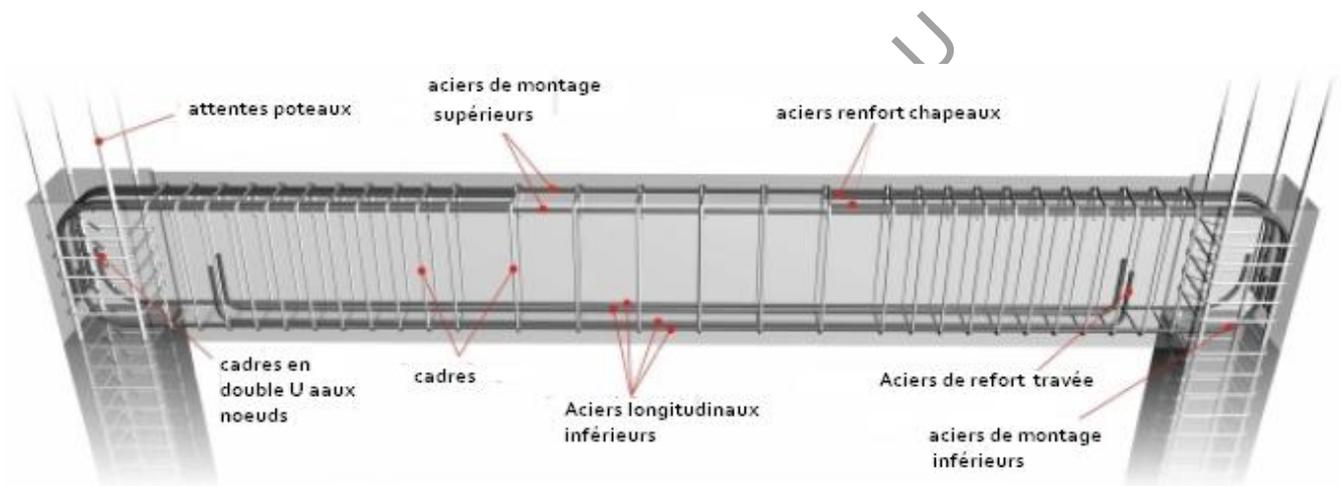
Armatures d'effort tranchant (cadres) le long d'une poutre
